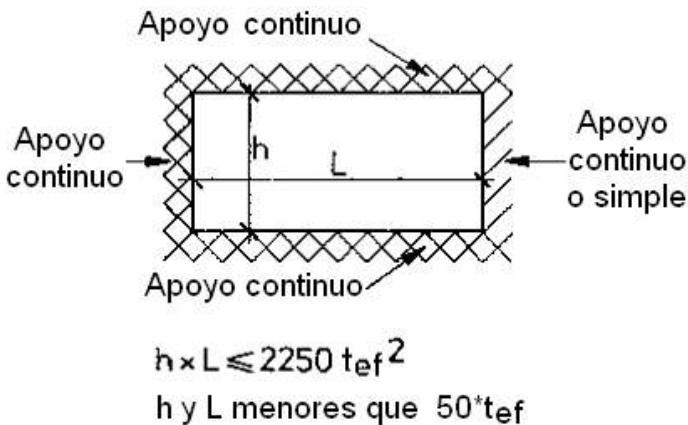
Muro con cuatro apoyos – 3 o más continuos.
